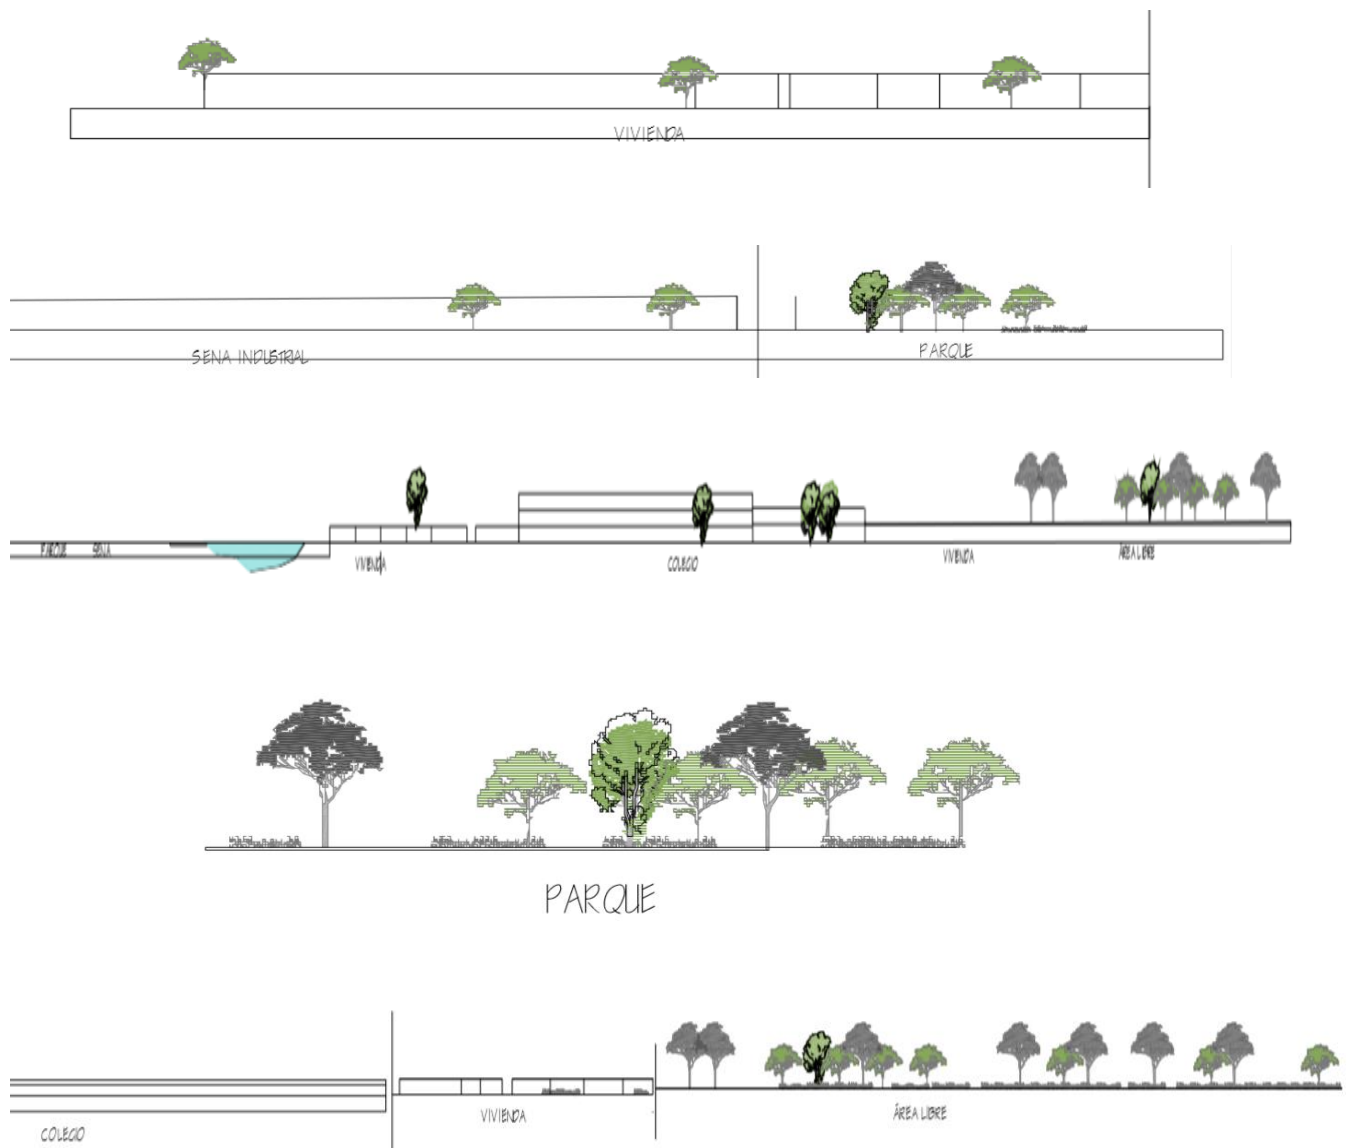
Alzado de Perfil viales de Puerto Amor. Fuente: Plancha N° 1aspectos Generales. Por: I. Medina. Y. Romero/Proyecto Integral De Barrio.
